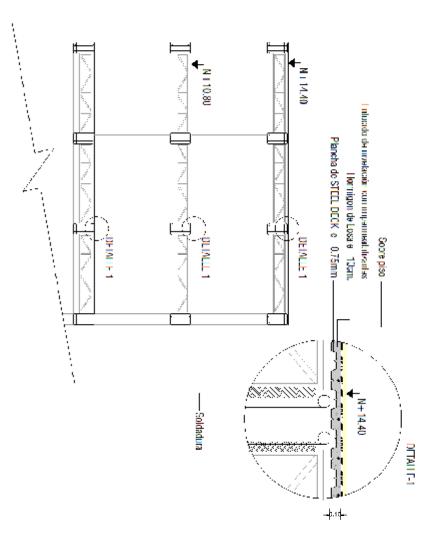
Detalle de losa., Fuente: Jaime Dávila, 2015
